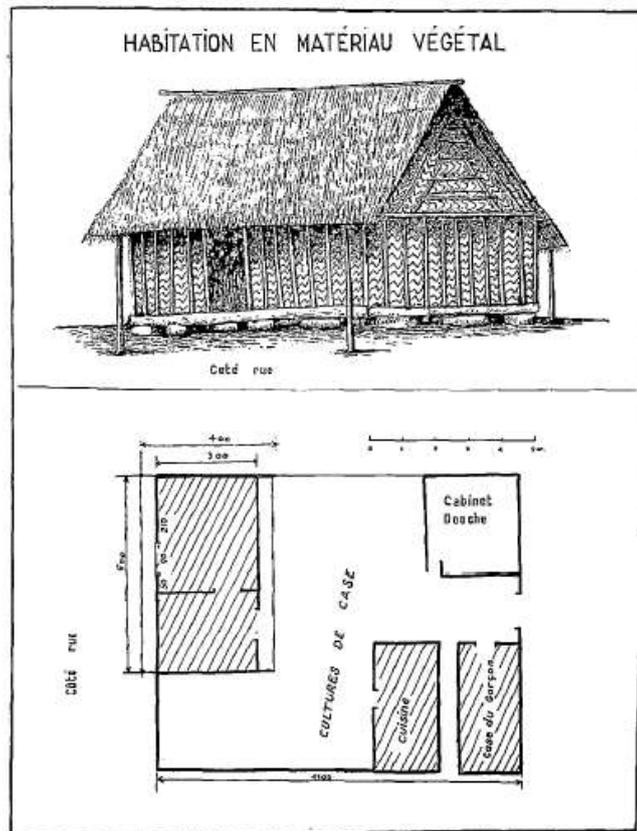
Maisons rurale, façade et plan, d'après C. Robineau 1966a, p. 88.
